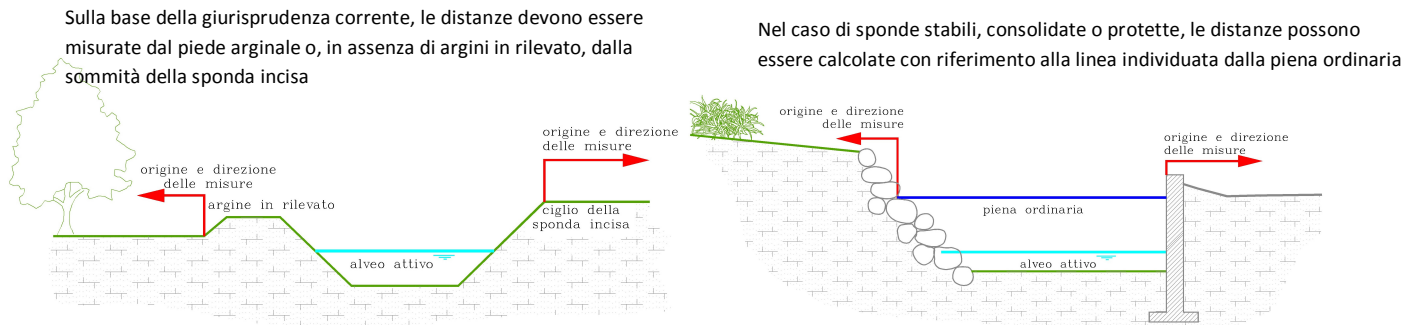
rappresentazione schematica delle modalità di misurazione delle fasce di rispetto
